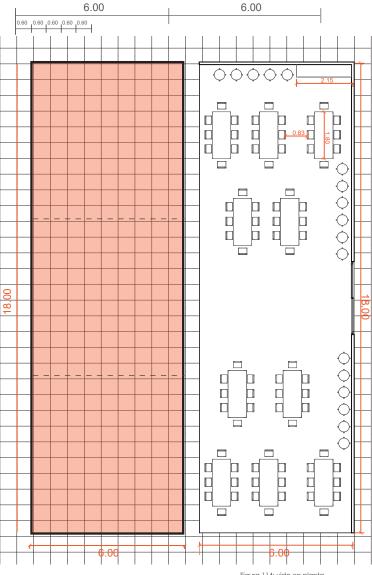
visto en planta Fuente: Elaboración propia, 2025
